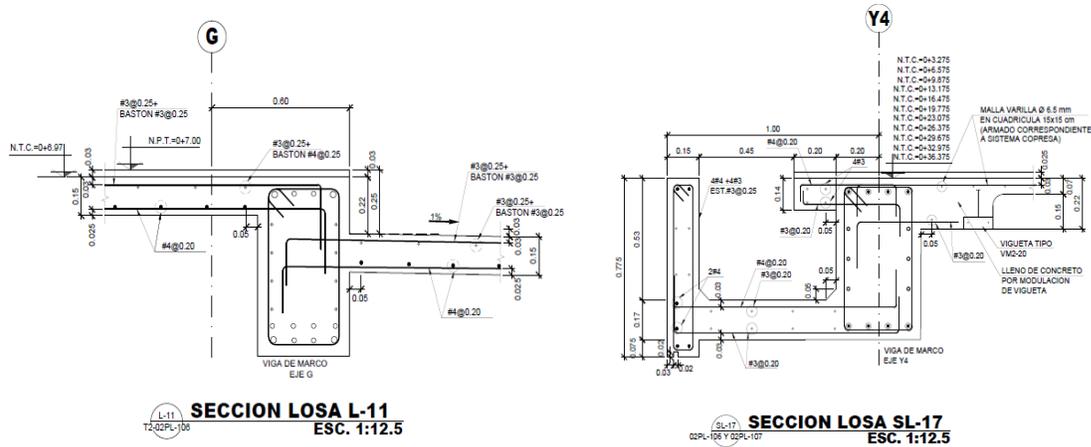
SECCIÓN TÍPICA DE CORTE DE LOSA
